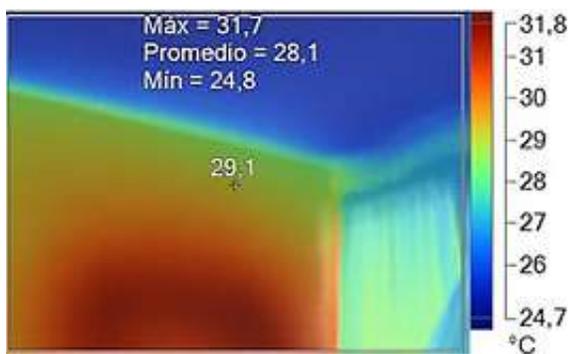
Muro Norte de Vivienda prototipo Bionatura.
